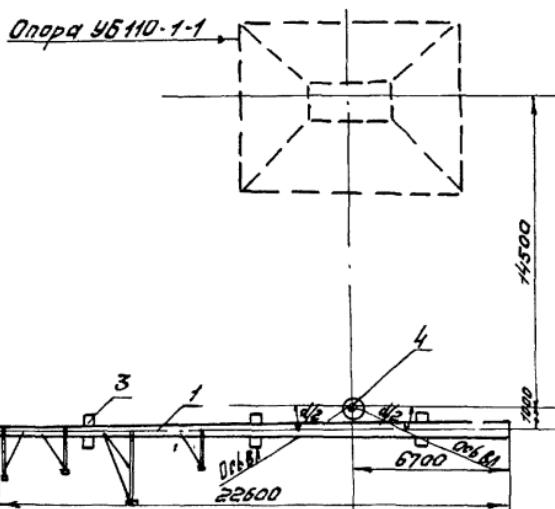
Схема выкладки и сборки опор: УБ 110-1-1; ПУБ 110-3; ПУБ 150-220-1
